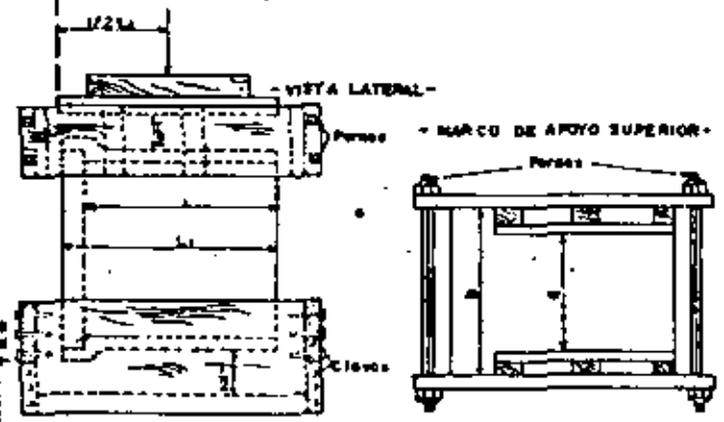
APOYOS DE ARENA PARA TUBOS DE CAJA Y ESPIGA
